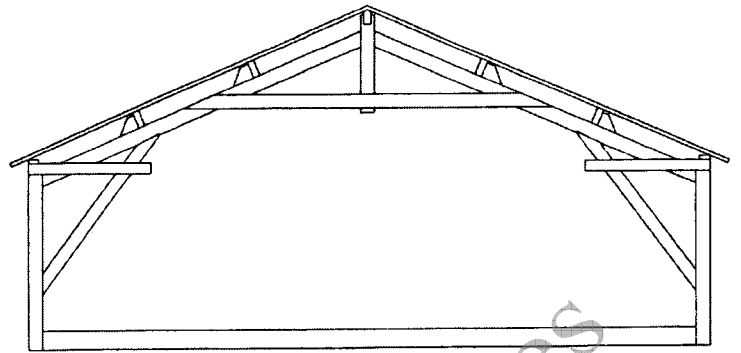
plan de coupe d'une ferme à entrain retroussé
